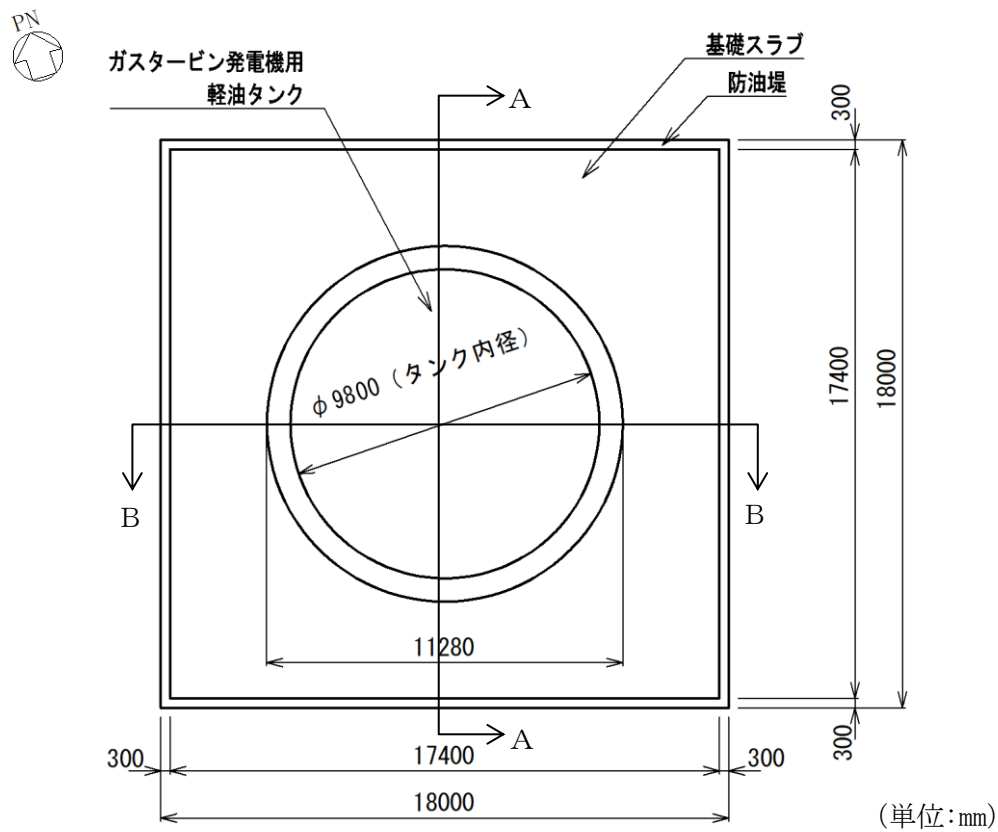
ガスタービン発電機用軽油タンク基礎 平面図
